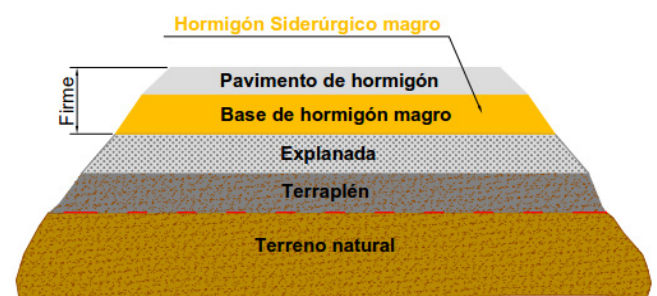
HORMIGÓN MAGRO VIBRADO EN BASES DE PAVIMENTOS DE HORMIGÓN.
